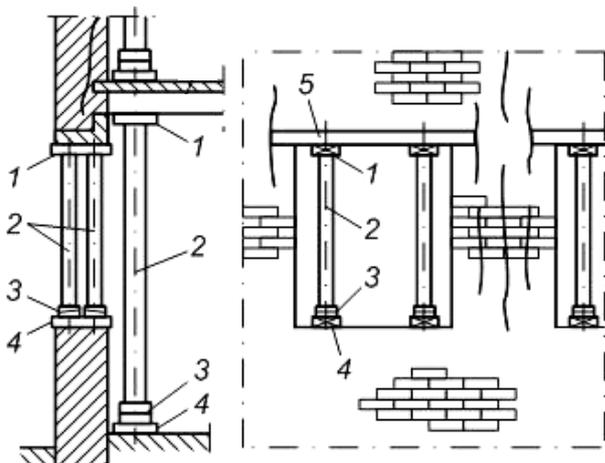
Усиление перекладкой простенков с временными креплениями в виде стоек с подклинкой: 1 – подкладка; 2 – стойка; 3 – клинья; 4 – лежень; 5 – перемычка
